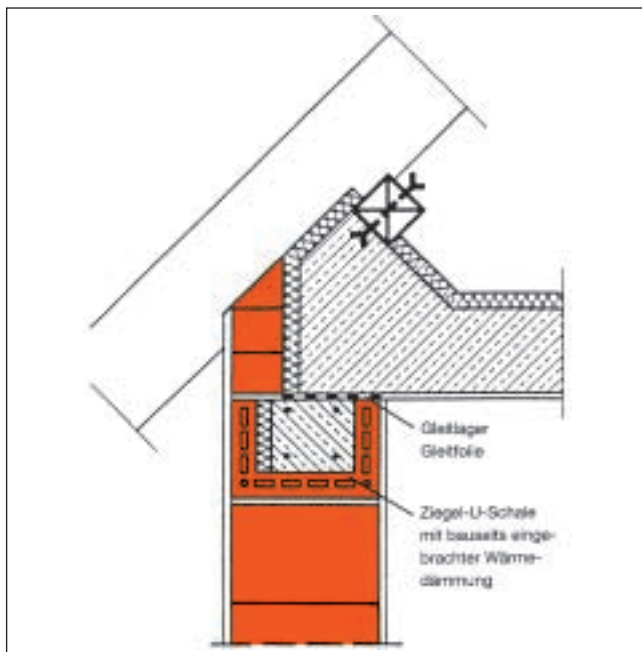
Ringbalken aus Ziegel-U-Schalen auf PlanZiegel-Mauerwerk
